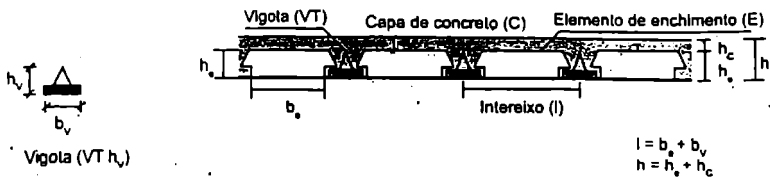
Laje pré-fabricada com vigotas treliçadas (LT).
